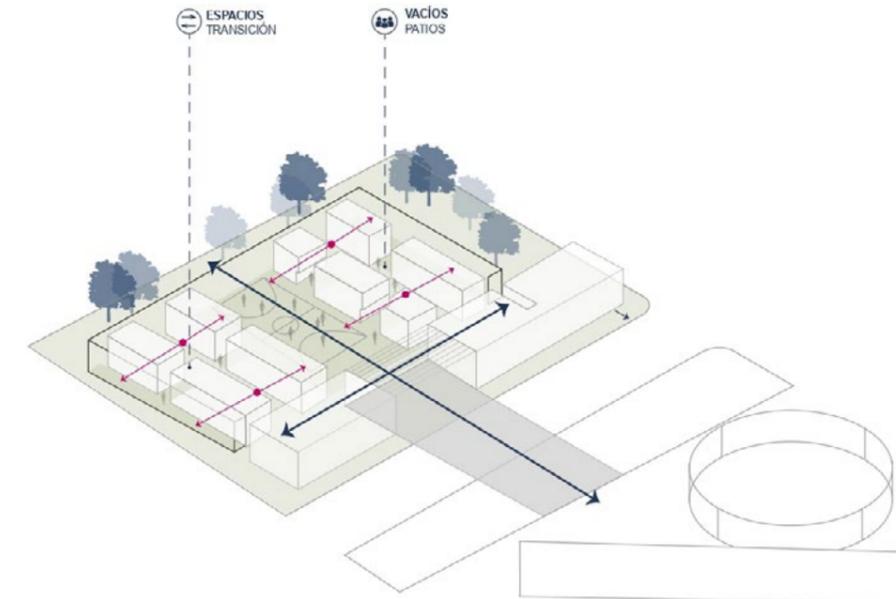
Zonas de transición: Colegio Pradera El Volcán. Fuente: Elaboración propia, 2025.
